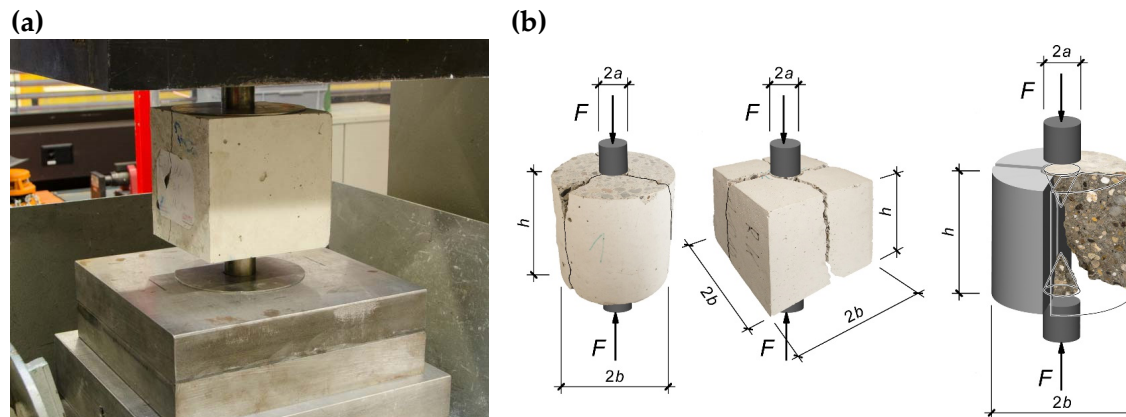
(a) Durchführung eines Stempeldruckversuchs an einem Betonwürfel in einer Druckprüfmaschine und (b) Bezeichnungen und Geometrie des Stempeldruckversuchs; Bilder des Autors.
